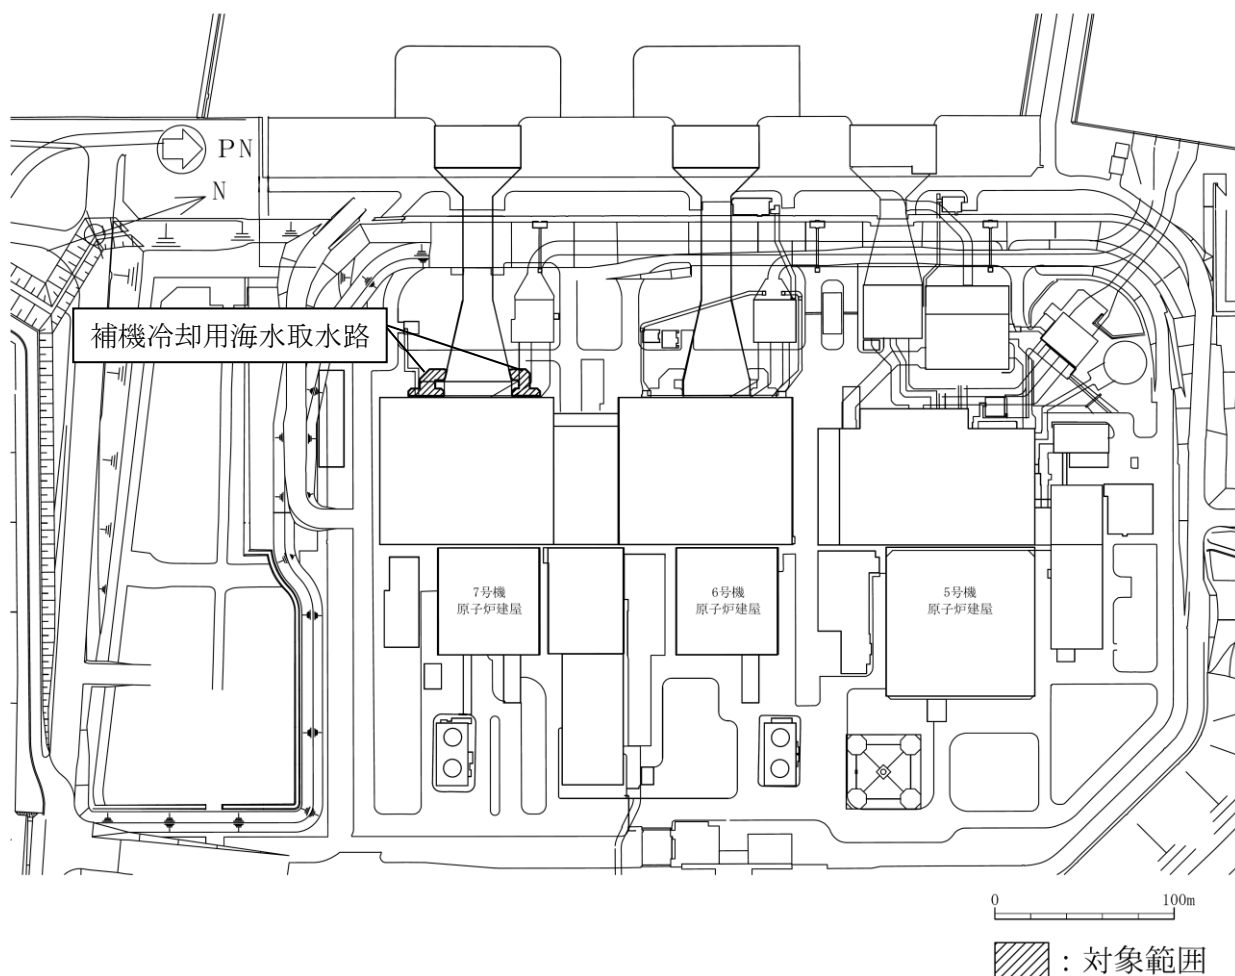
補機冷却用海水取水路の平面配置図（平面図）
